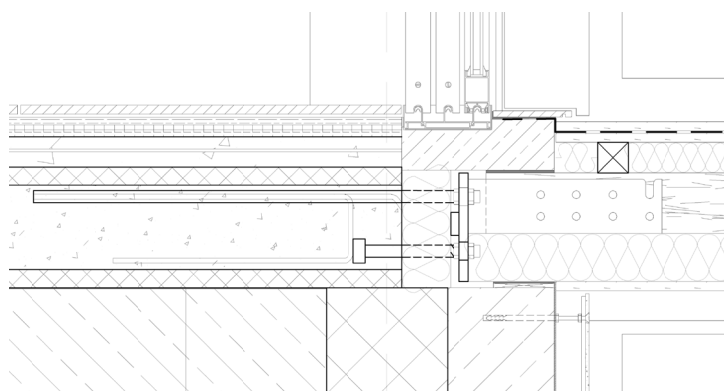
Dettaglio di fissaggio dei balconi nella soletta
